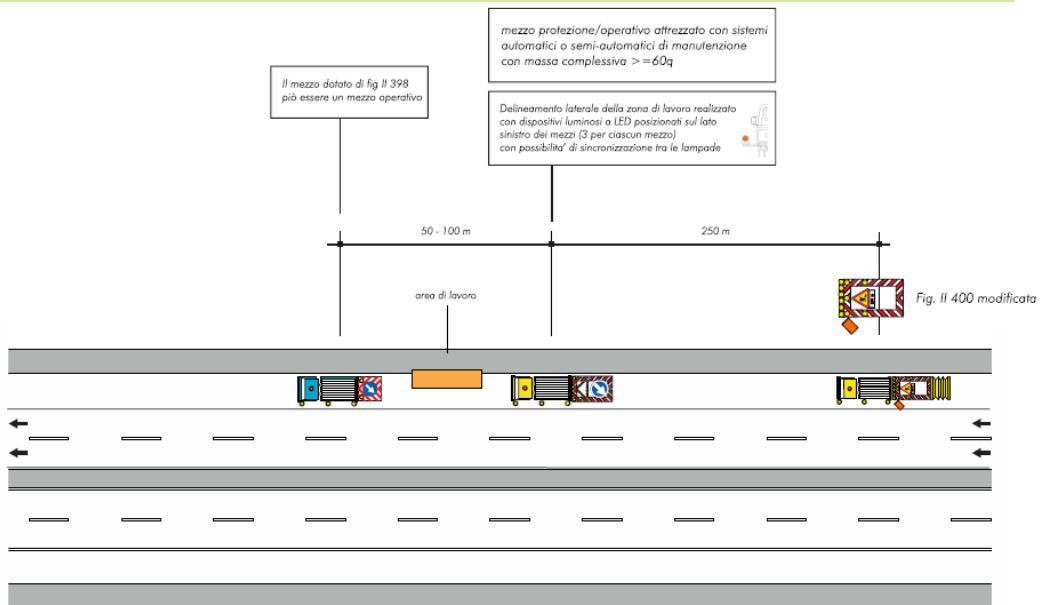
Tecne Tavola M2- Cantieri in avanzamento
